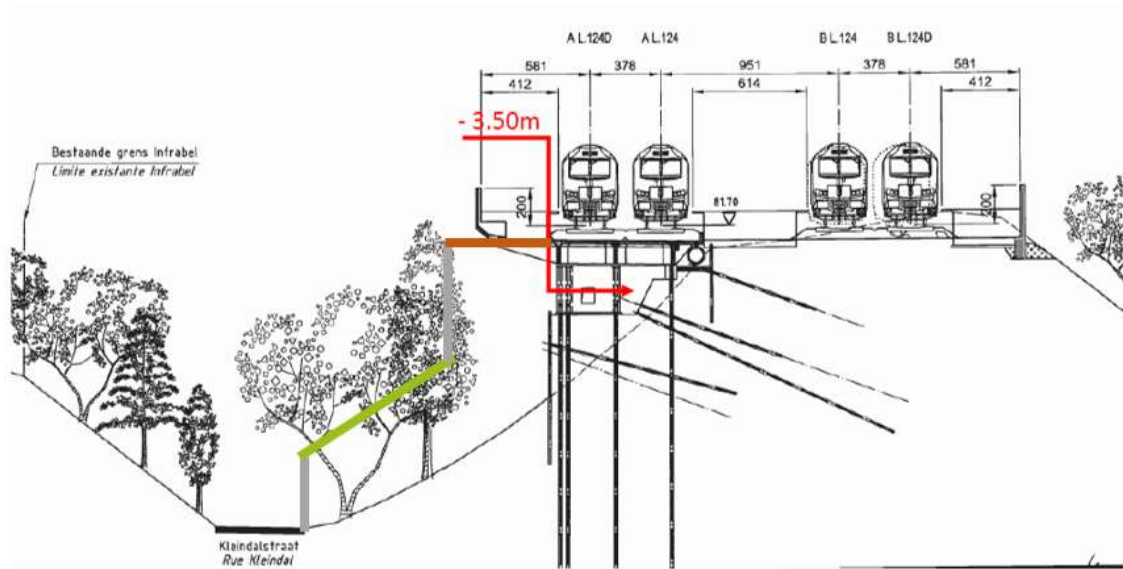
Kleindalstraat – alternatief 2 (bron: TUCrail + eigen bewerking)
